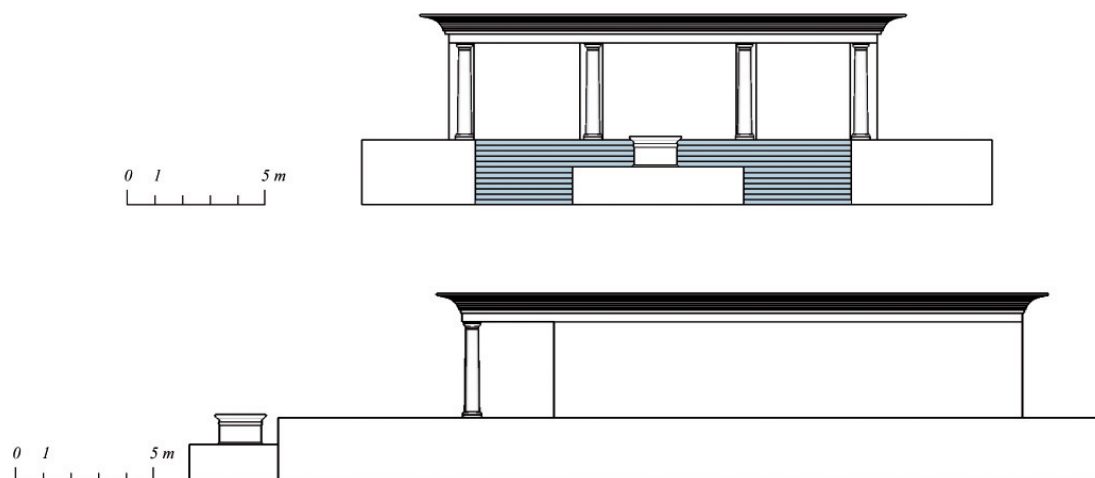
Proposta di restituzione dell'alzato del tempio della terza fase: in alto prospetto frontale; in basso prospetto laterale (Elab. dell'A.)
